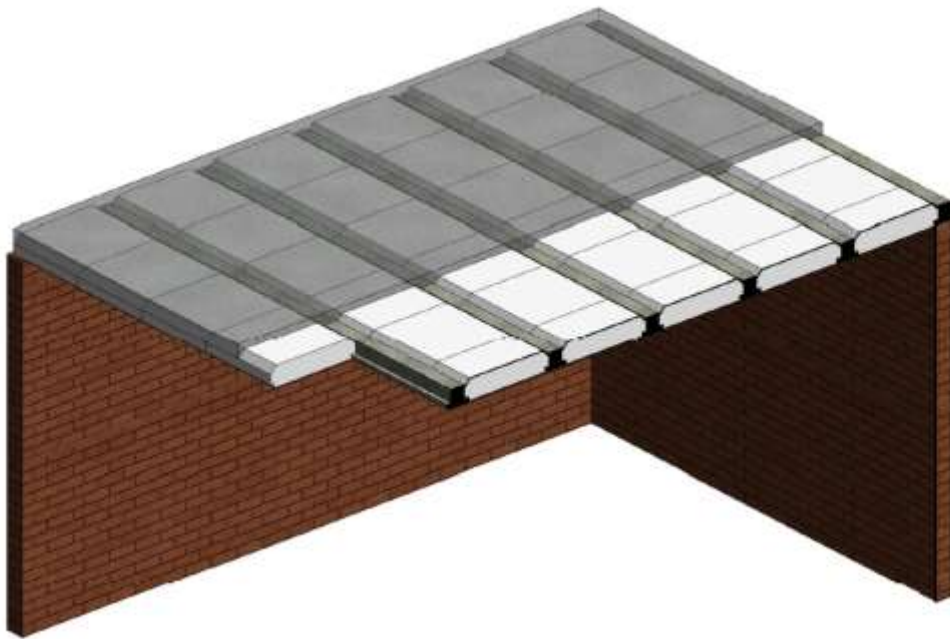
Esquema de montaje de viguetas-Bovedillas de EPS-Capa de Hormigón.
